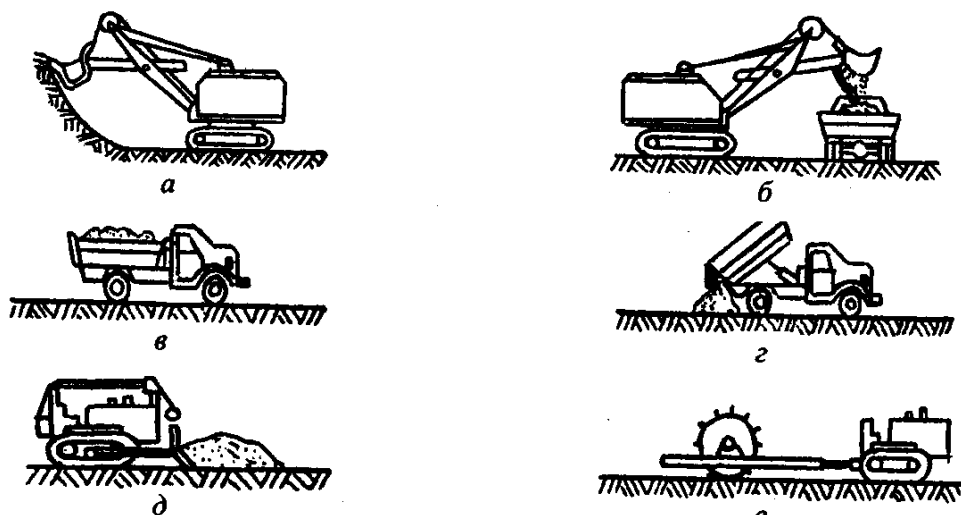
Схема комплексной механизации земляных работ при разработке грунта экскаватором: а – разработка грунта; б – погрузка на автосамосвал; в – транспортирование грунта; г – разгрузка; д – разравнивание грунта бульдозером; е - уплотнение
